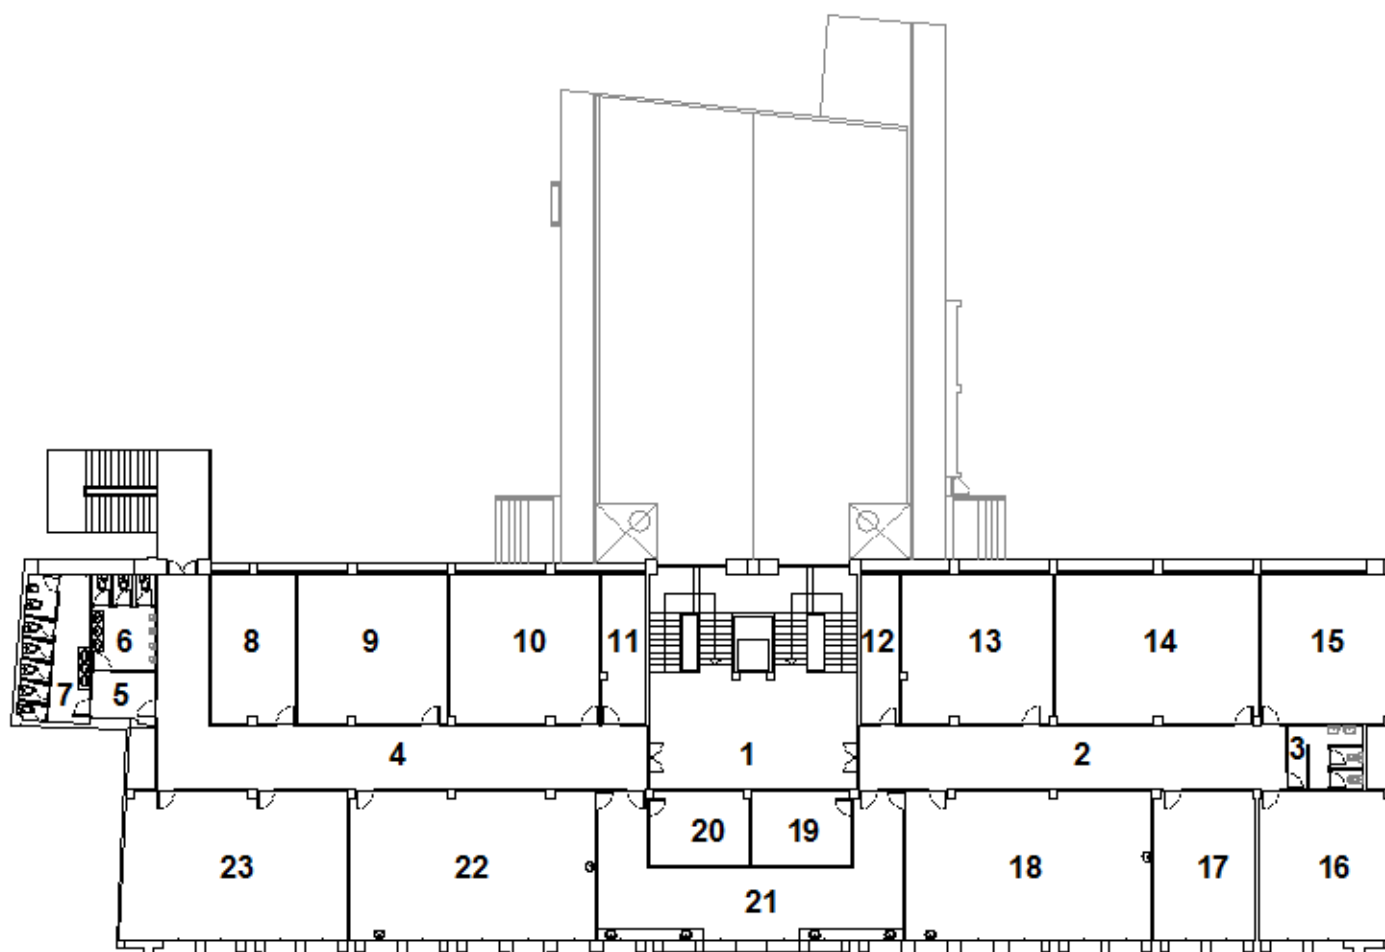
Distribución planta tercera. Fuente: Elaboración propia.
